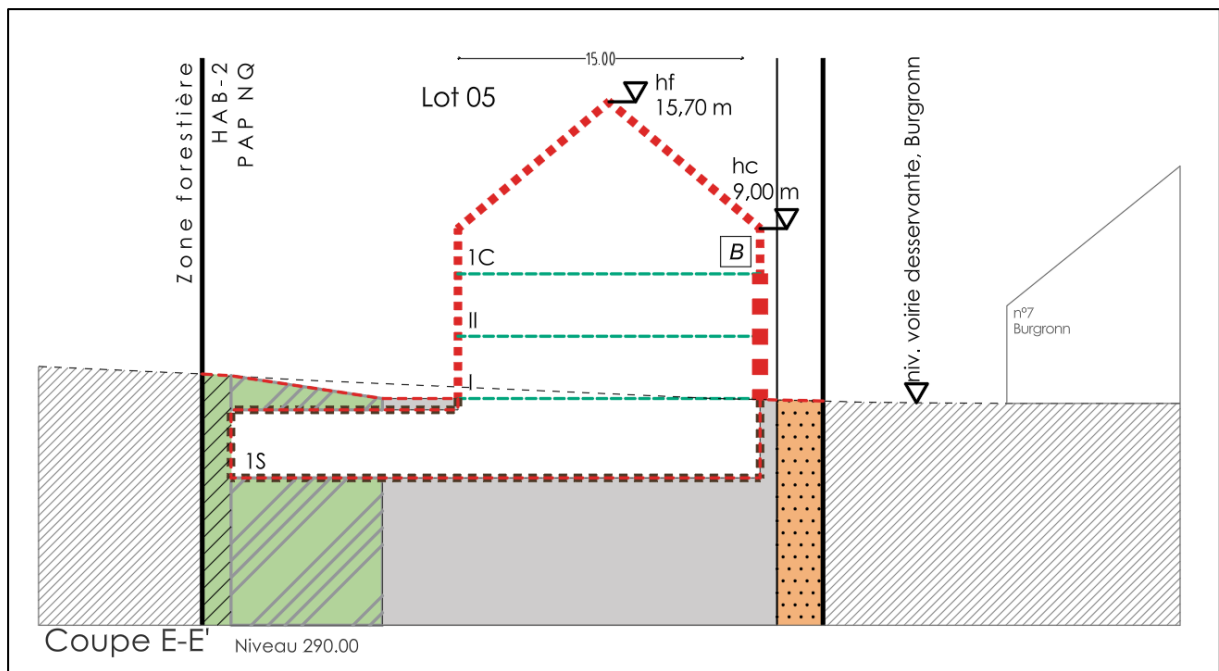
Coupes illustrant l'insertion de la construction du lot 05 sur le terrain naturel.
